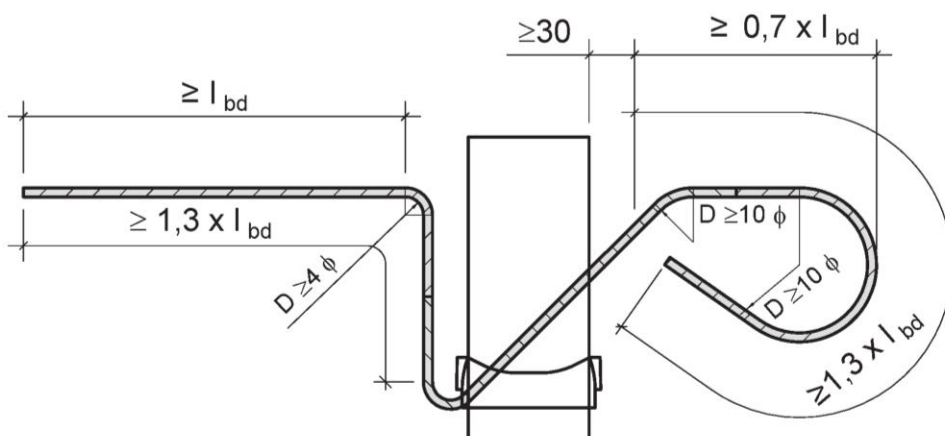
Schöck Isokorb® Typ K (Variante Höhenversatz)
